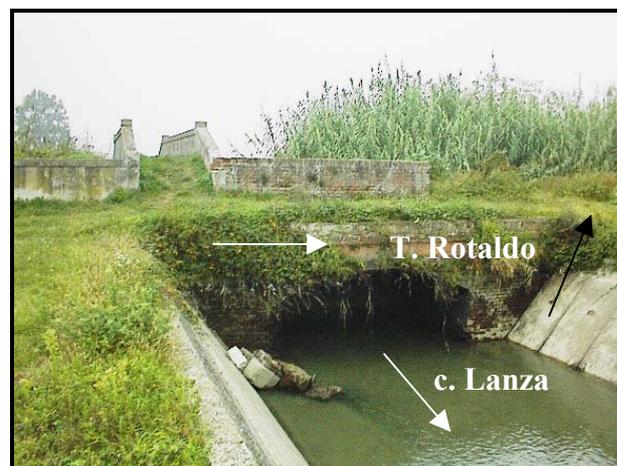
Vista del sifone da valle e del secondo ponte sul canale Lanza.
